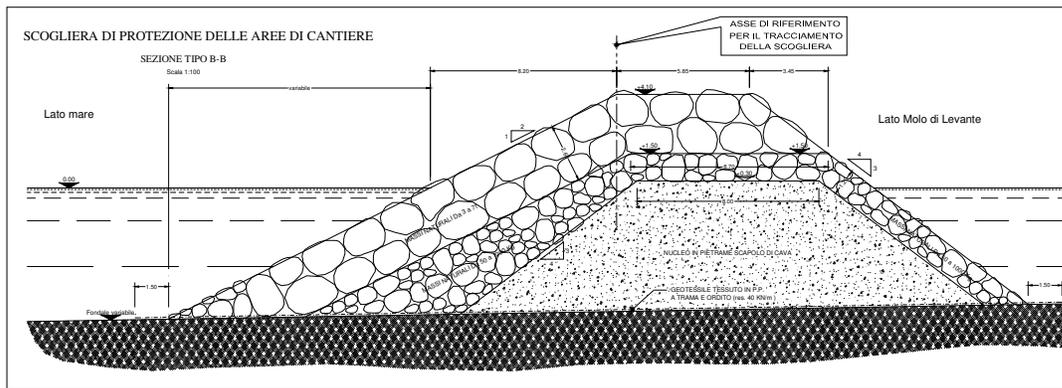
Sezione tipo della scogliera provvisoria a difesa delle aree di cantiere
